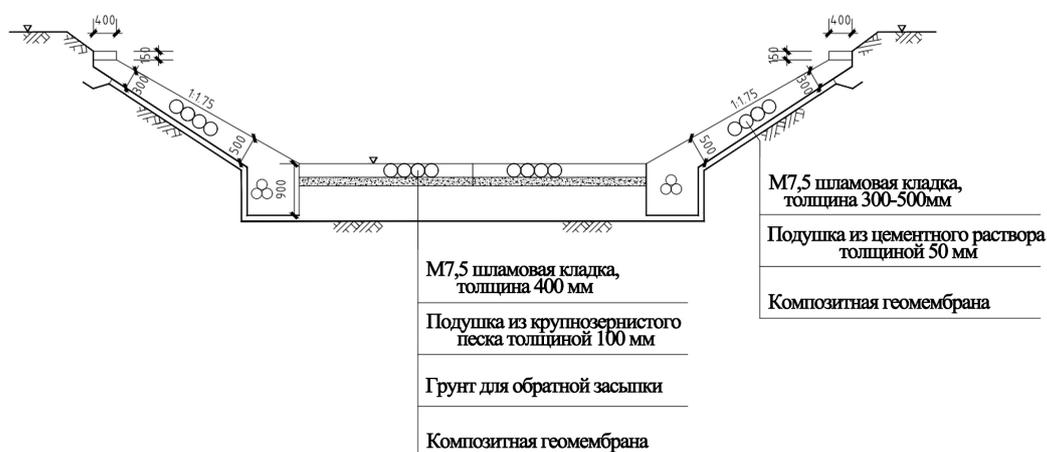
Крепление из шламовой кладки на слое композитной геомембраны
